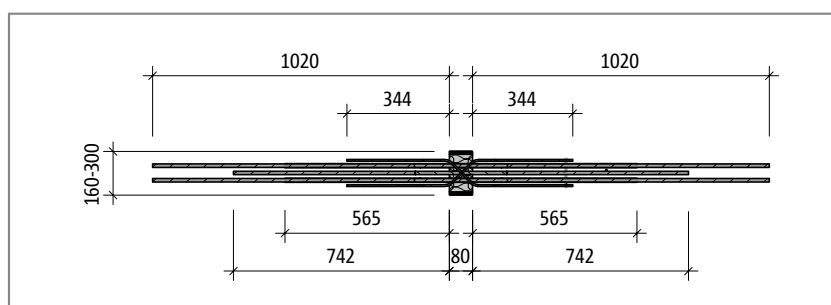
Schöck Isokorb® T Type W-M4 : Plan de base du produit
